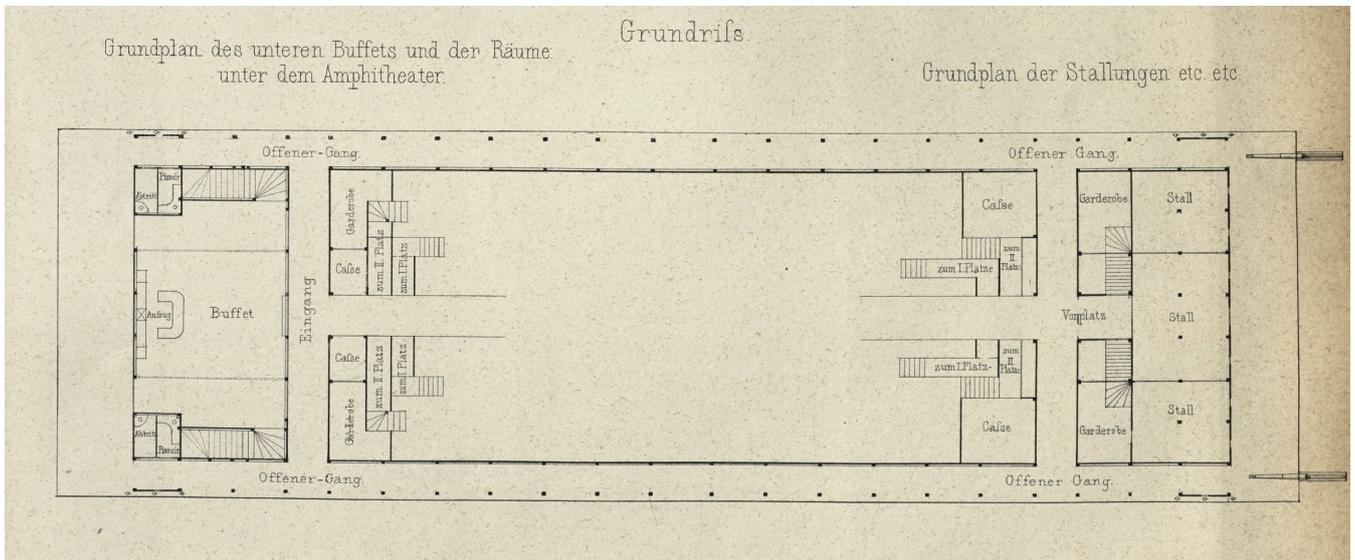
Grundriss bzw. Grundplan der unteren Räume und Stallungen.
